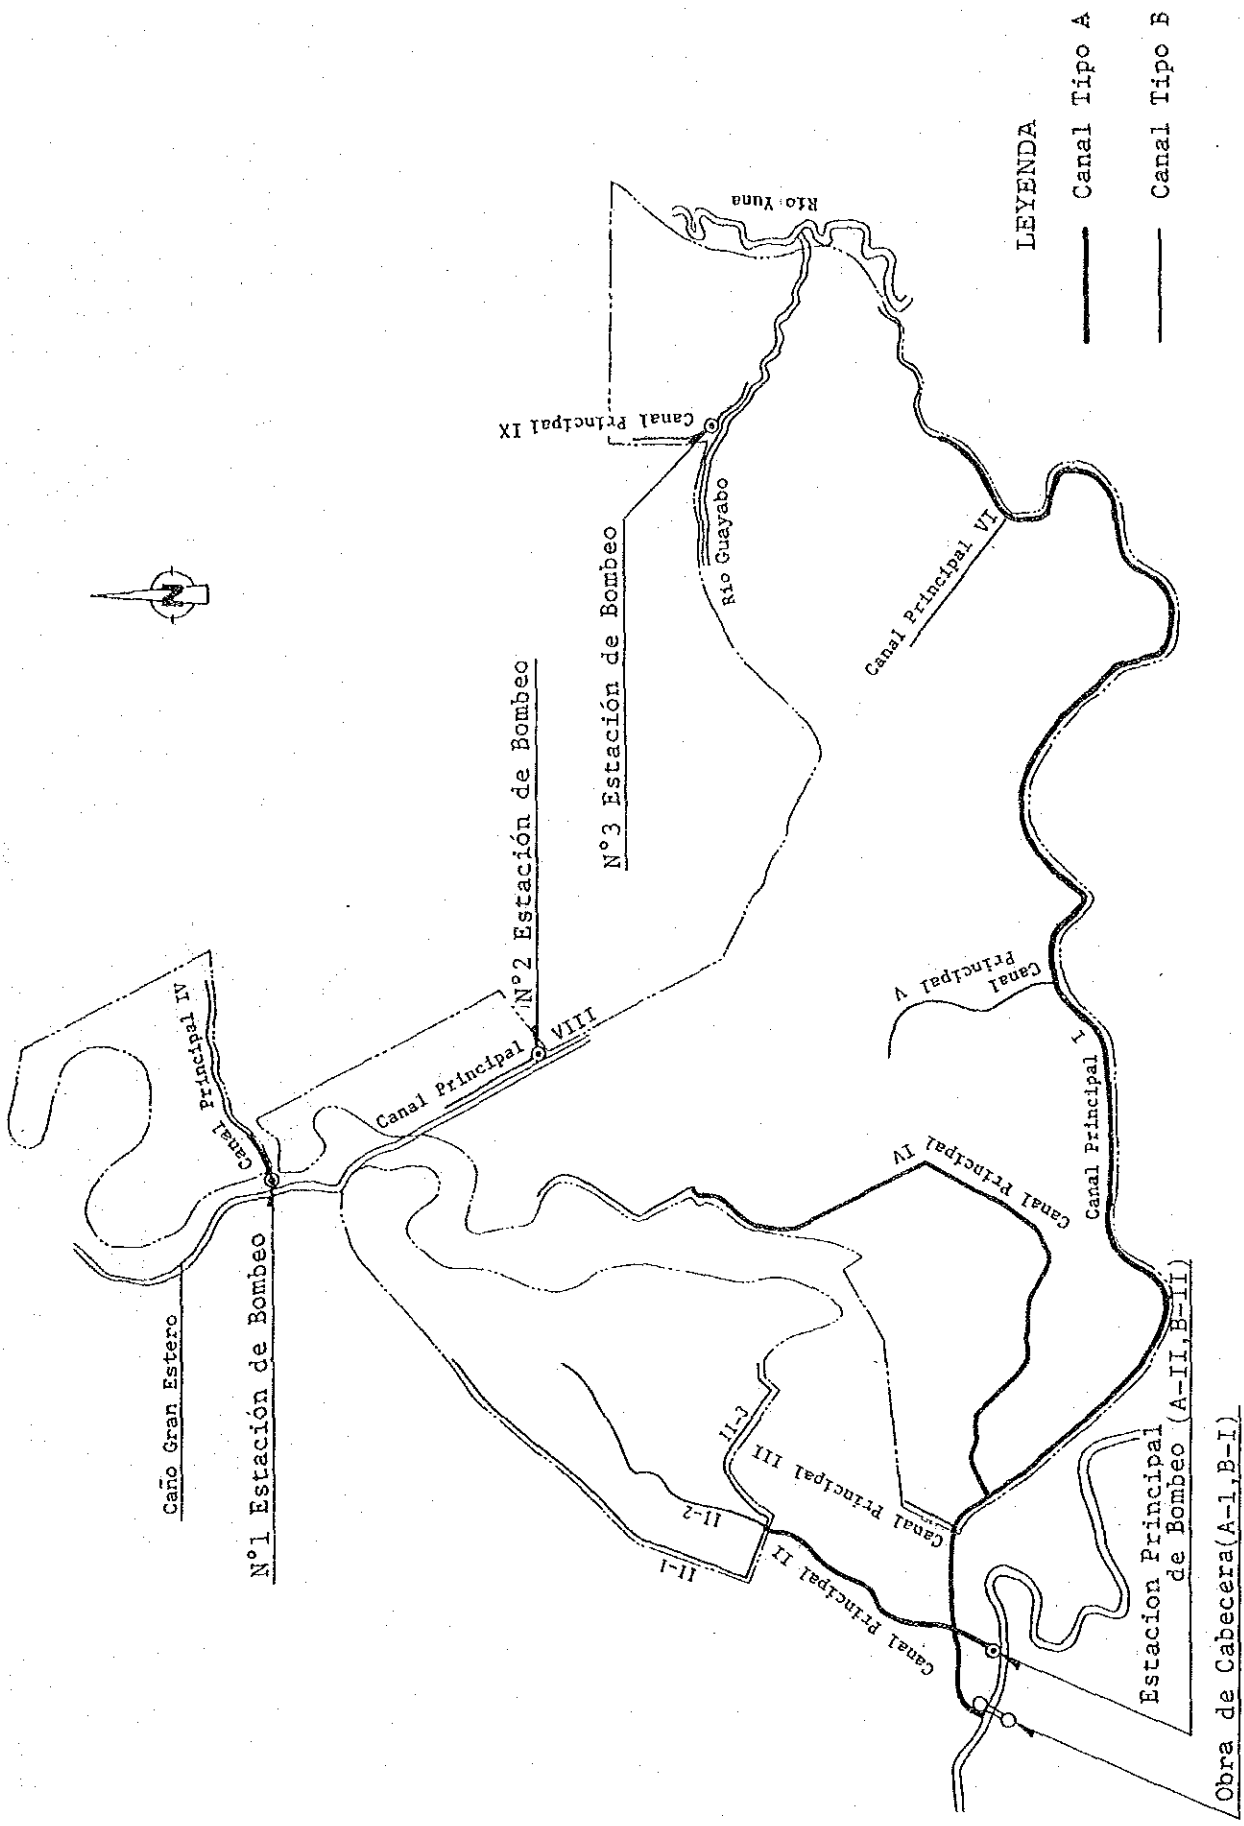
PLANO GENERAL DE CANAL PRINCIPAL DE RIEGO
